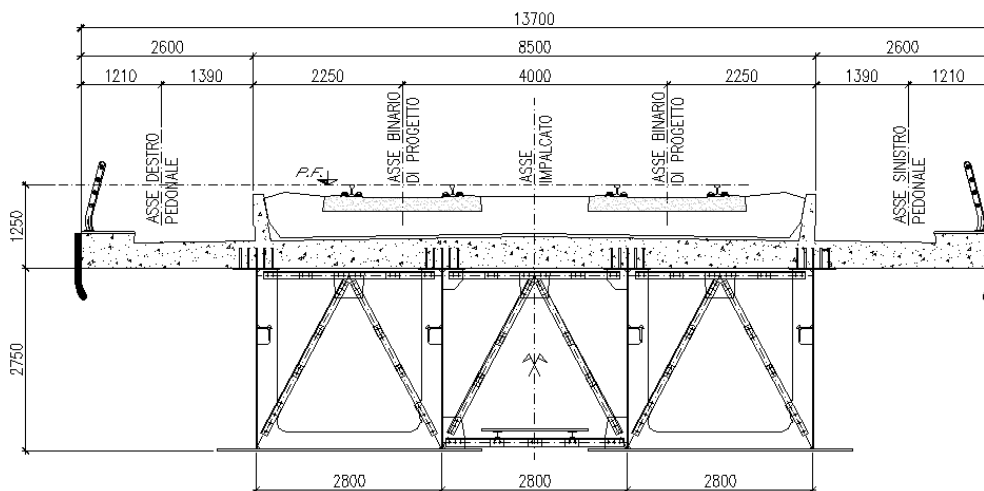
Sezione trasversale architettonica (H2,75m)
